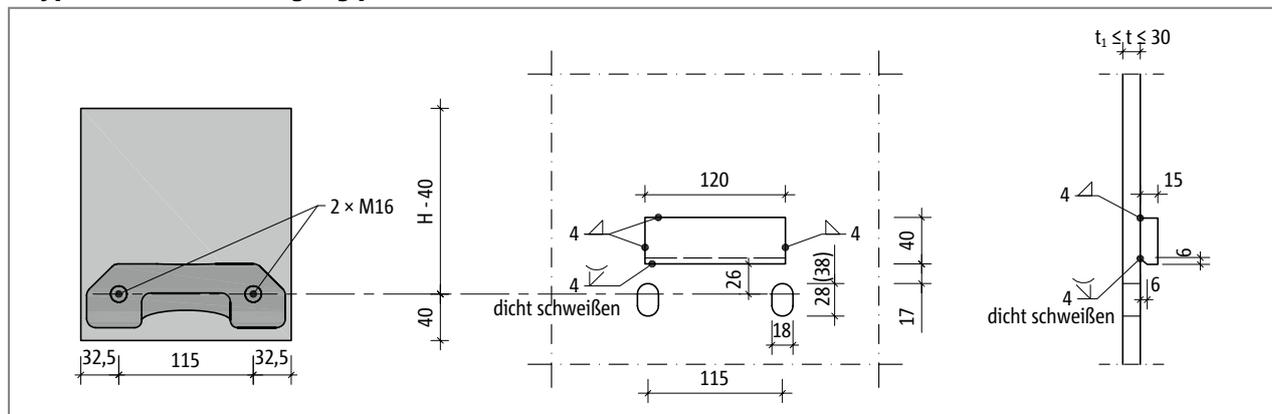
Schöck Isokorb® T Typ SQ: Konstruktion des Stirnplattenanschlusses
